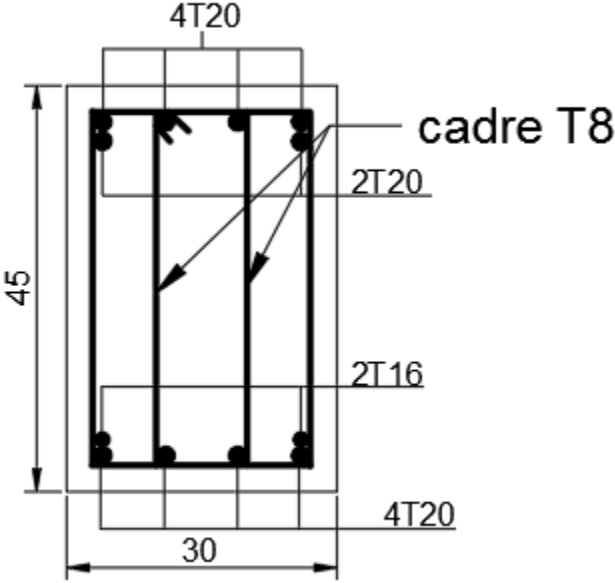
Ferrailage des poutres porteuses sur appui
